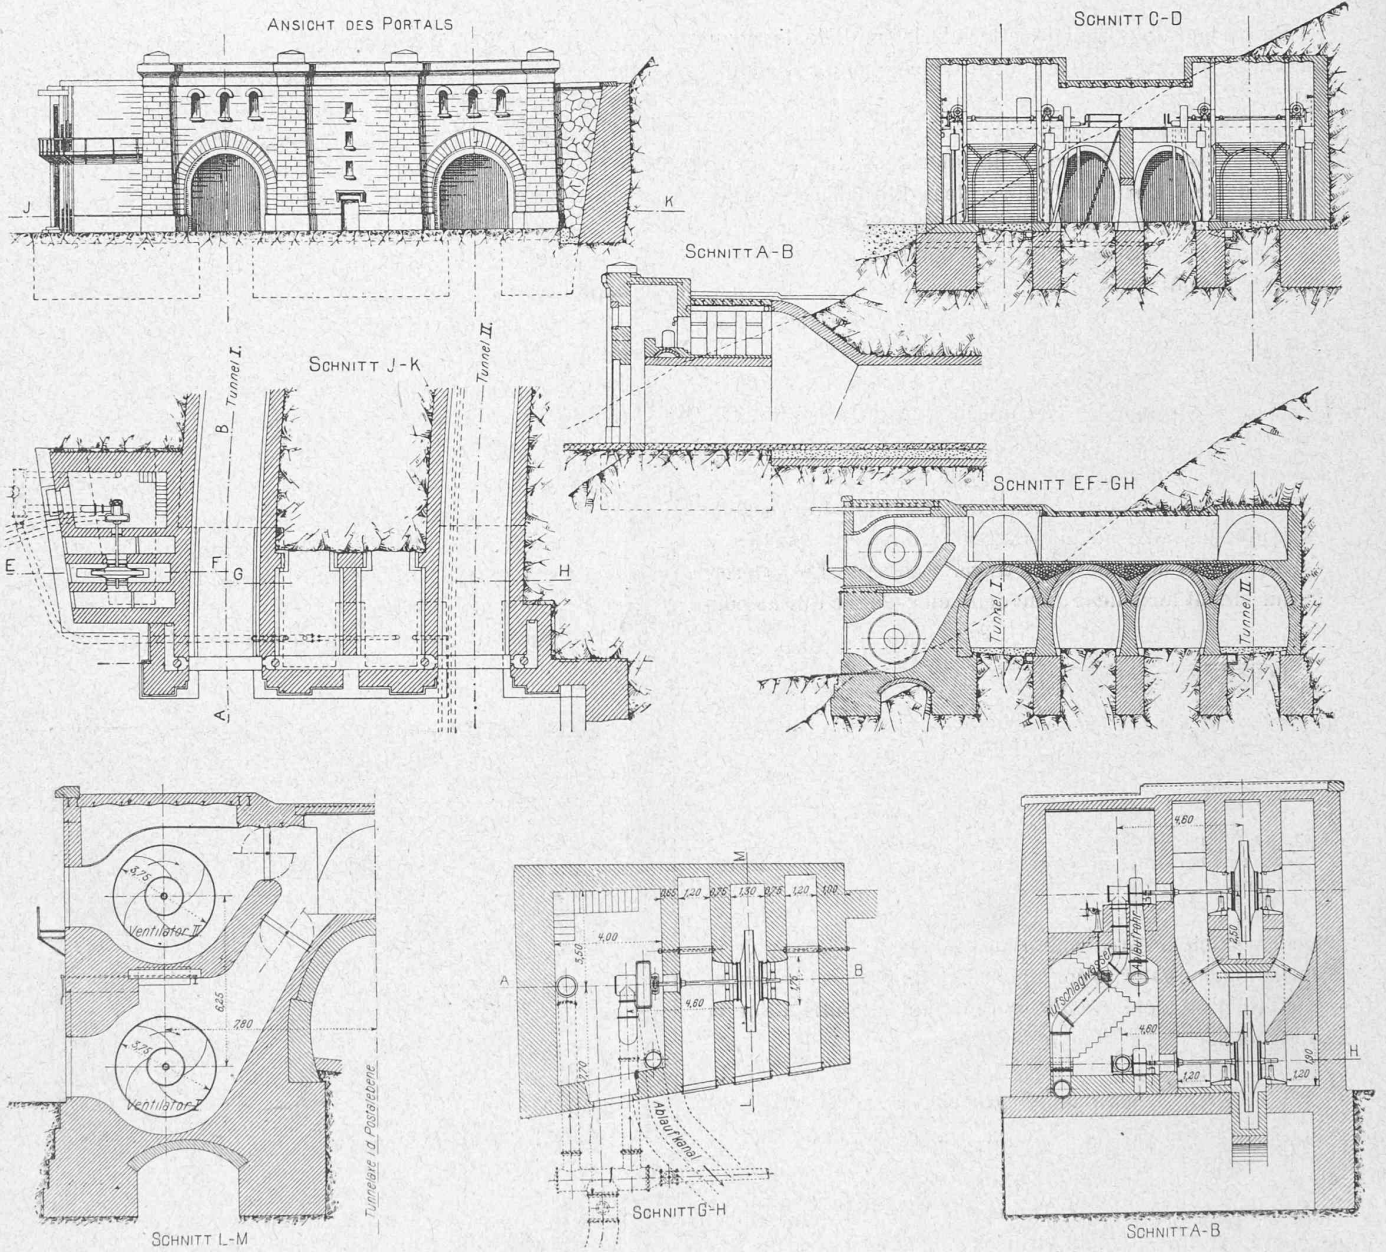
à 12. — Elevation, plan et coupes des installations de la ventilation du tunnel, côté de Brigue.
